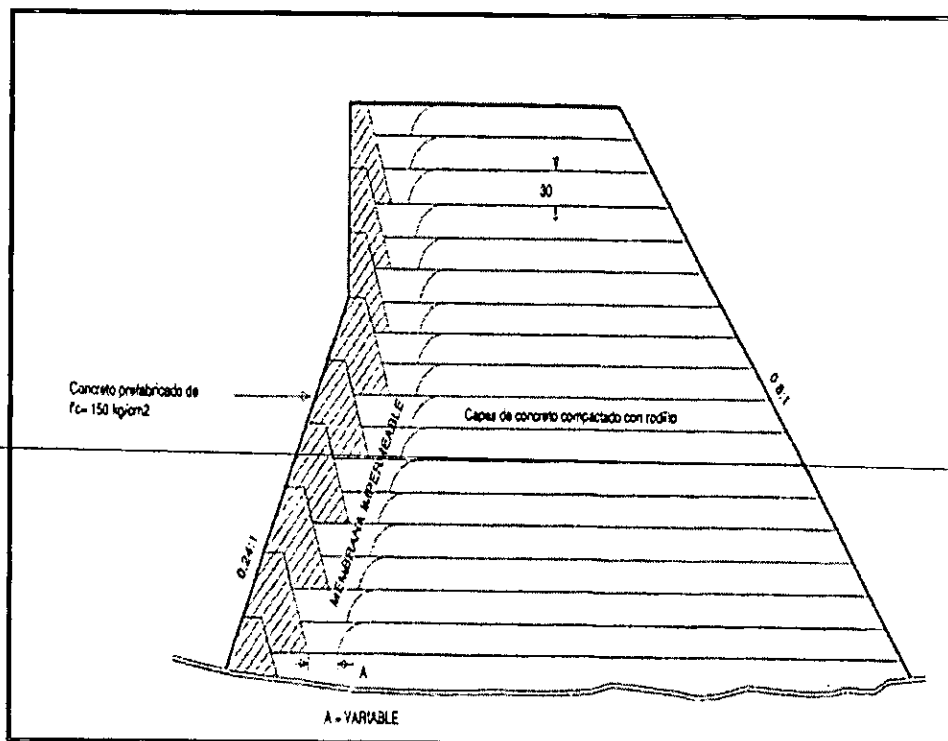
Detalle del proceso de colocación de capas de concreto compactado con rodillo.
